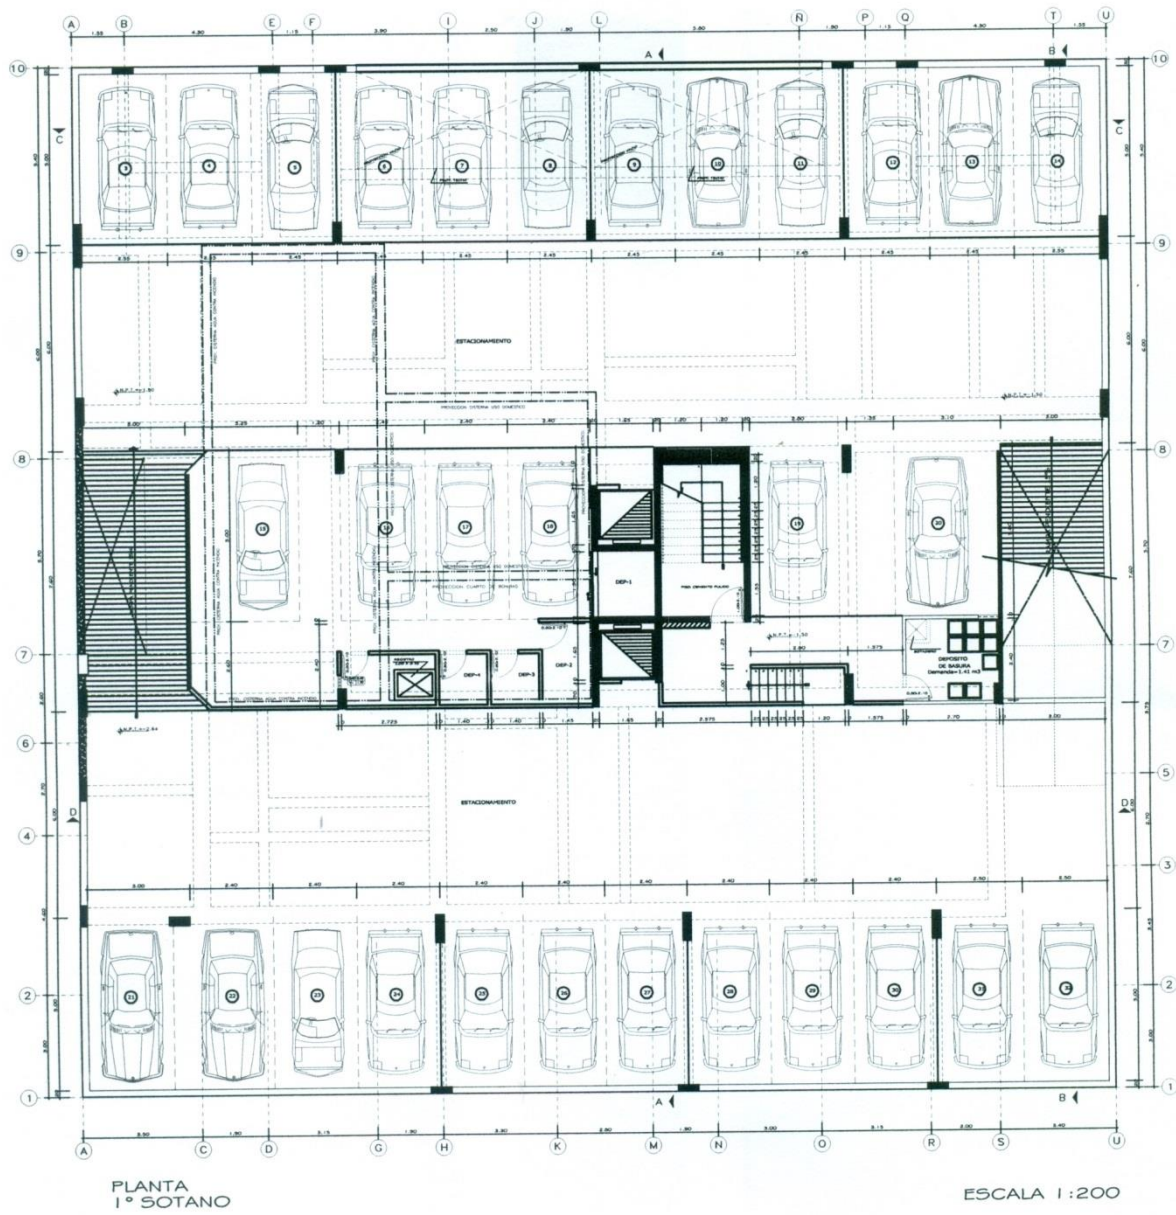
Plano de planta del sótano 1 del proyecto Edificio Asturias
